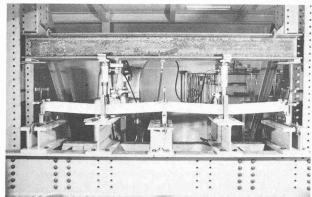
Essai de poutre continue jusqu'à la ruine.
